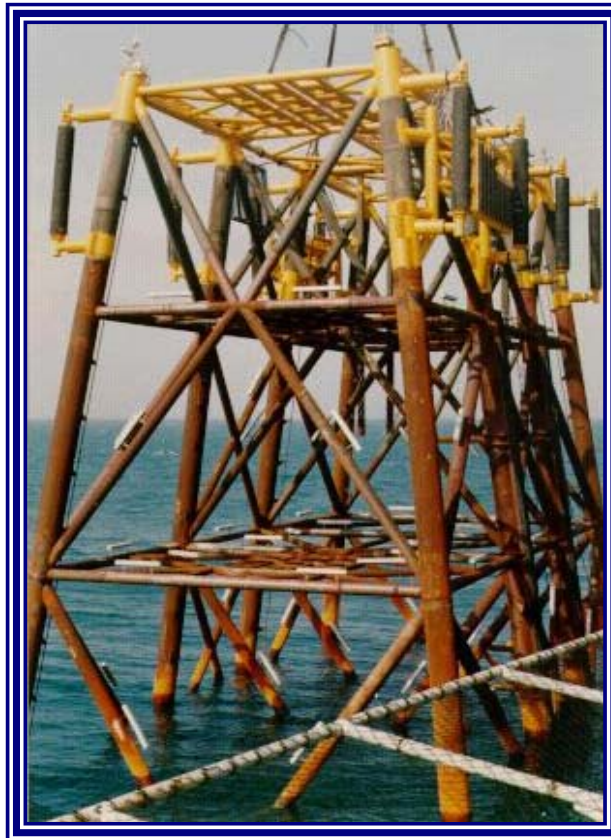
SUBESTRUCTURA CON ACCESORIOS DURANTE POSICIONAMIENTO VERTICAL.
